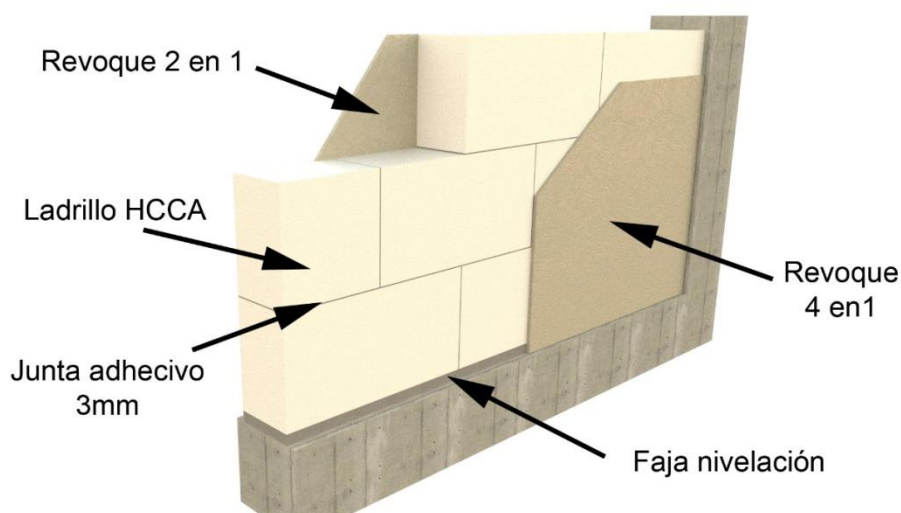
Detalle del muro Tipo C, de construcción mixta.
